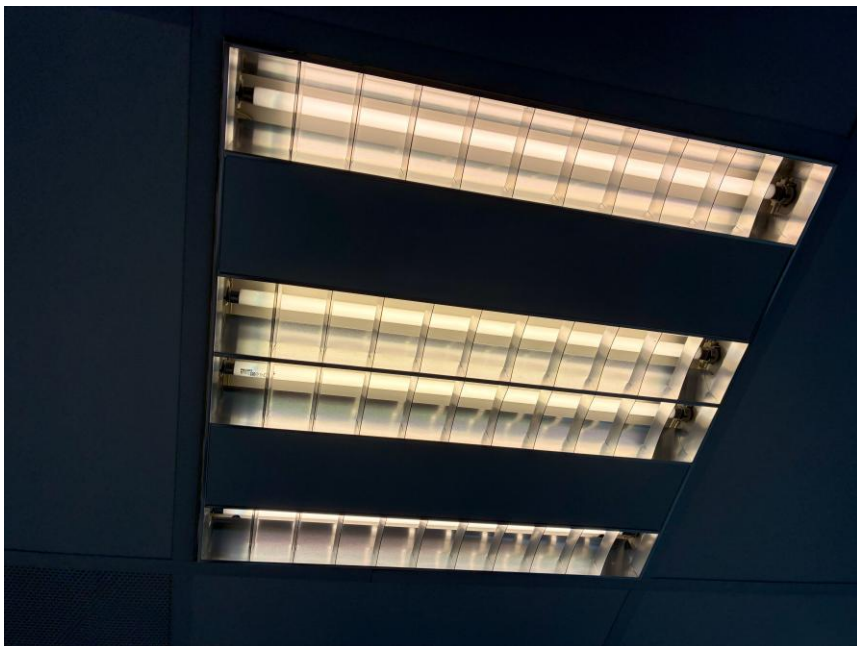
Detailfoto van verlichtingstype G in kantoren voorzijde Gemeentewerf Waalwijk
